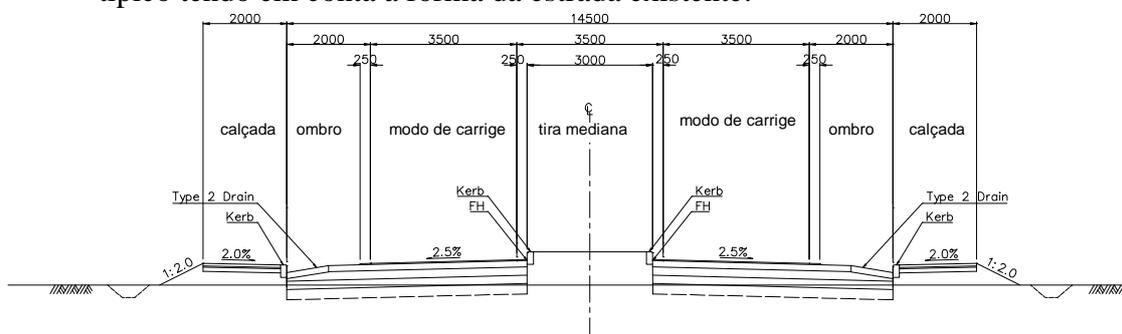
Perfil Transversal Típico Proposto (Mandimba-sede)
